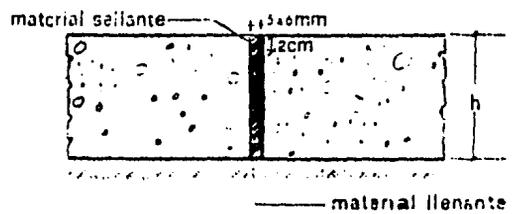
Detalles recomendados de diseño para junta transversal de expansión en carreteras
